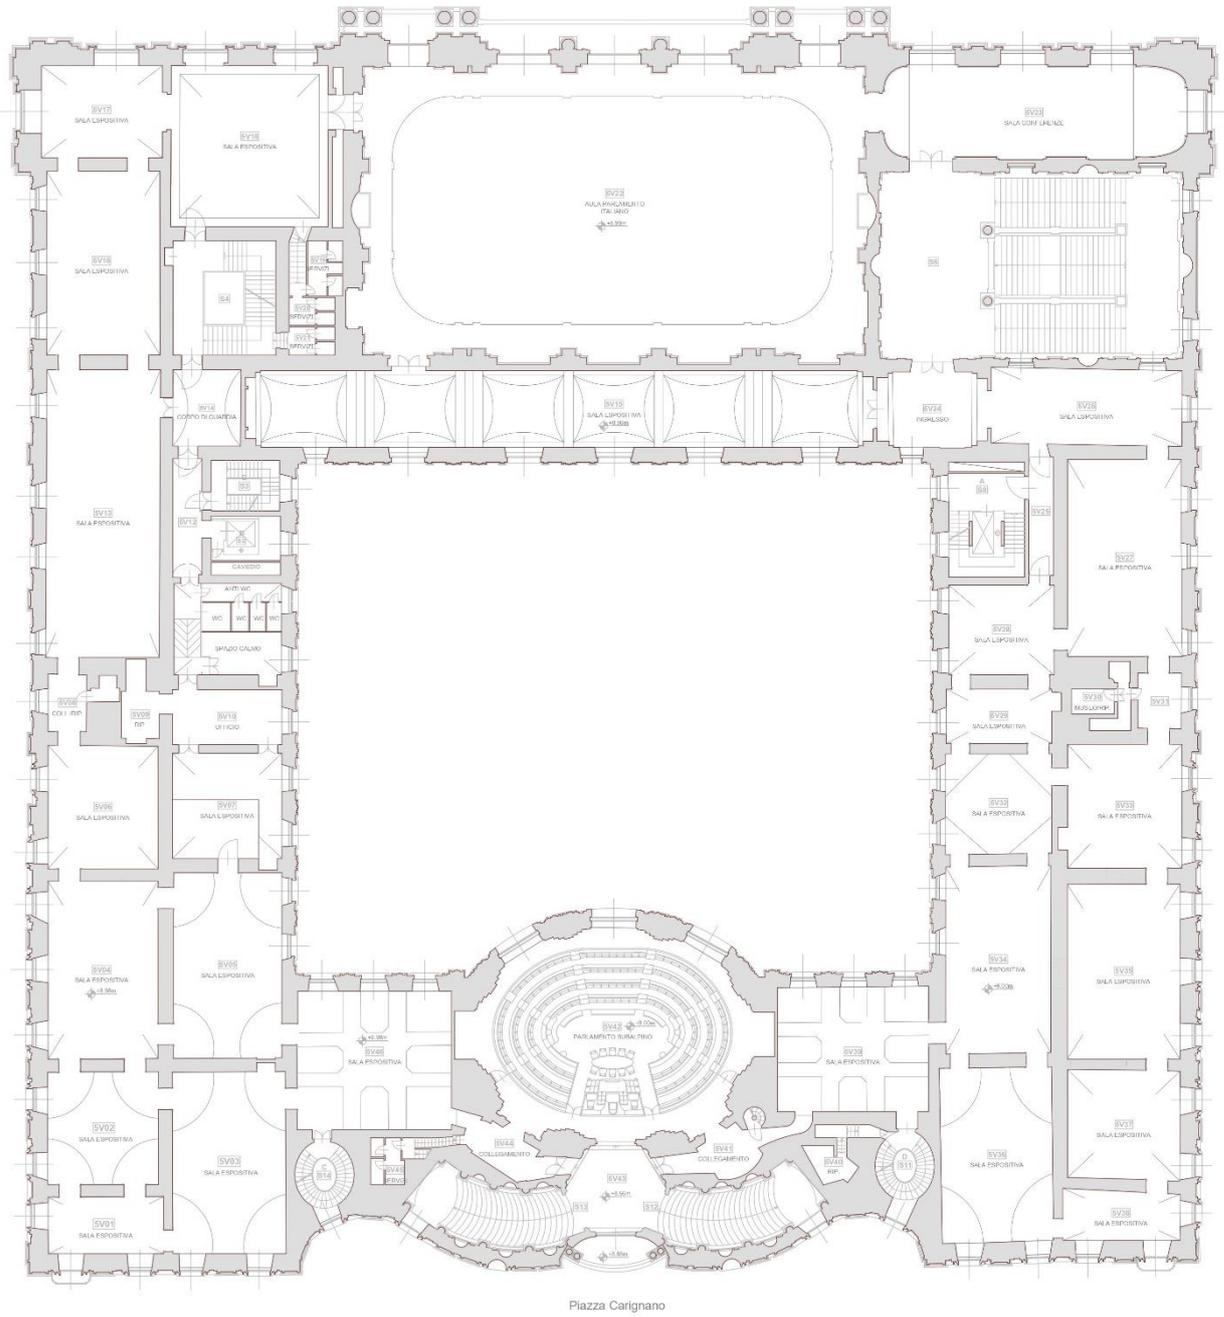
Pianta piano terzo, livello +3 (Fuori scala).
